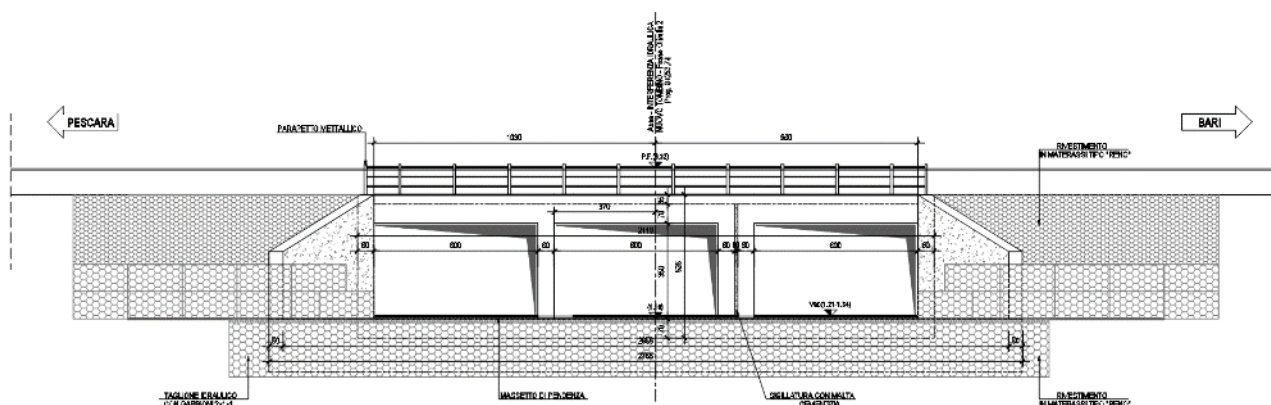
Adeguamento idraulico Fosso Olivella 2 – Prospetto del manufatto a tripla canna
